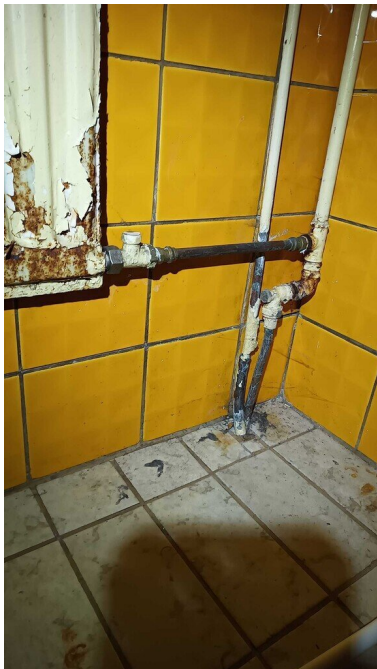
Pesuhuone- ja saunatilat olivat ikääntyneet ja huonokuntoiset eikä tiloissa havaittu nykyaikaista vedeneristettä. Pesuhuoneessa osa seinä- ja lattialaatoista hajalla.
